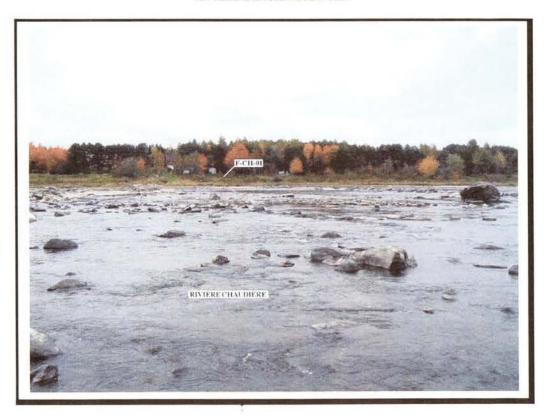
Environnement et positionnement du forage F-CH-01, Rivière Chaudière vers l'est
